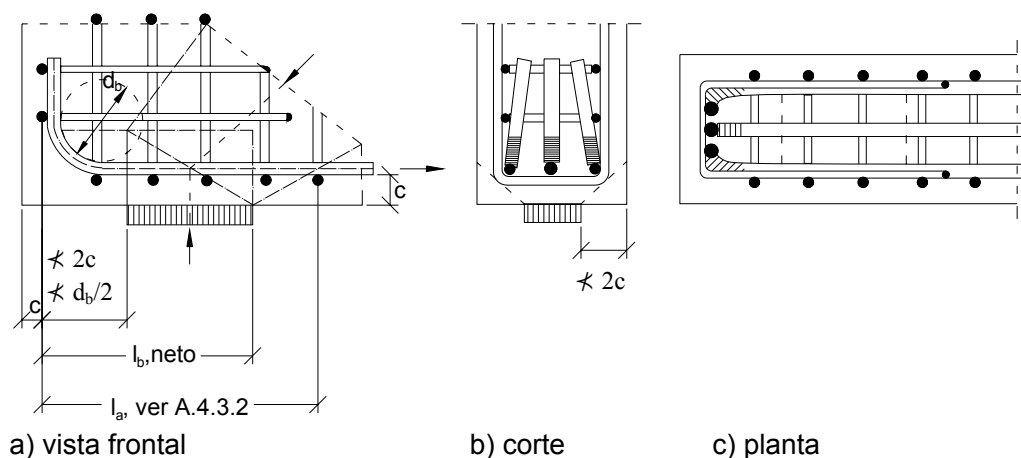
Detallado en un apoyo en el extremo de una viga con gancho normal
